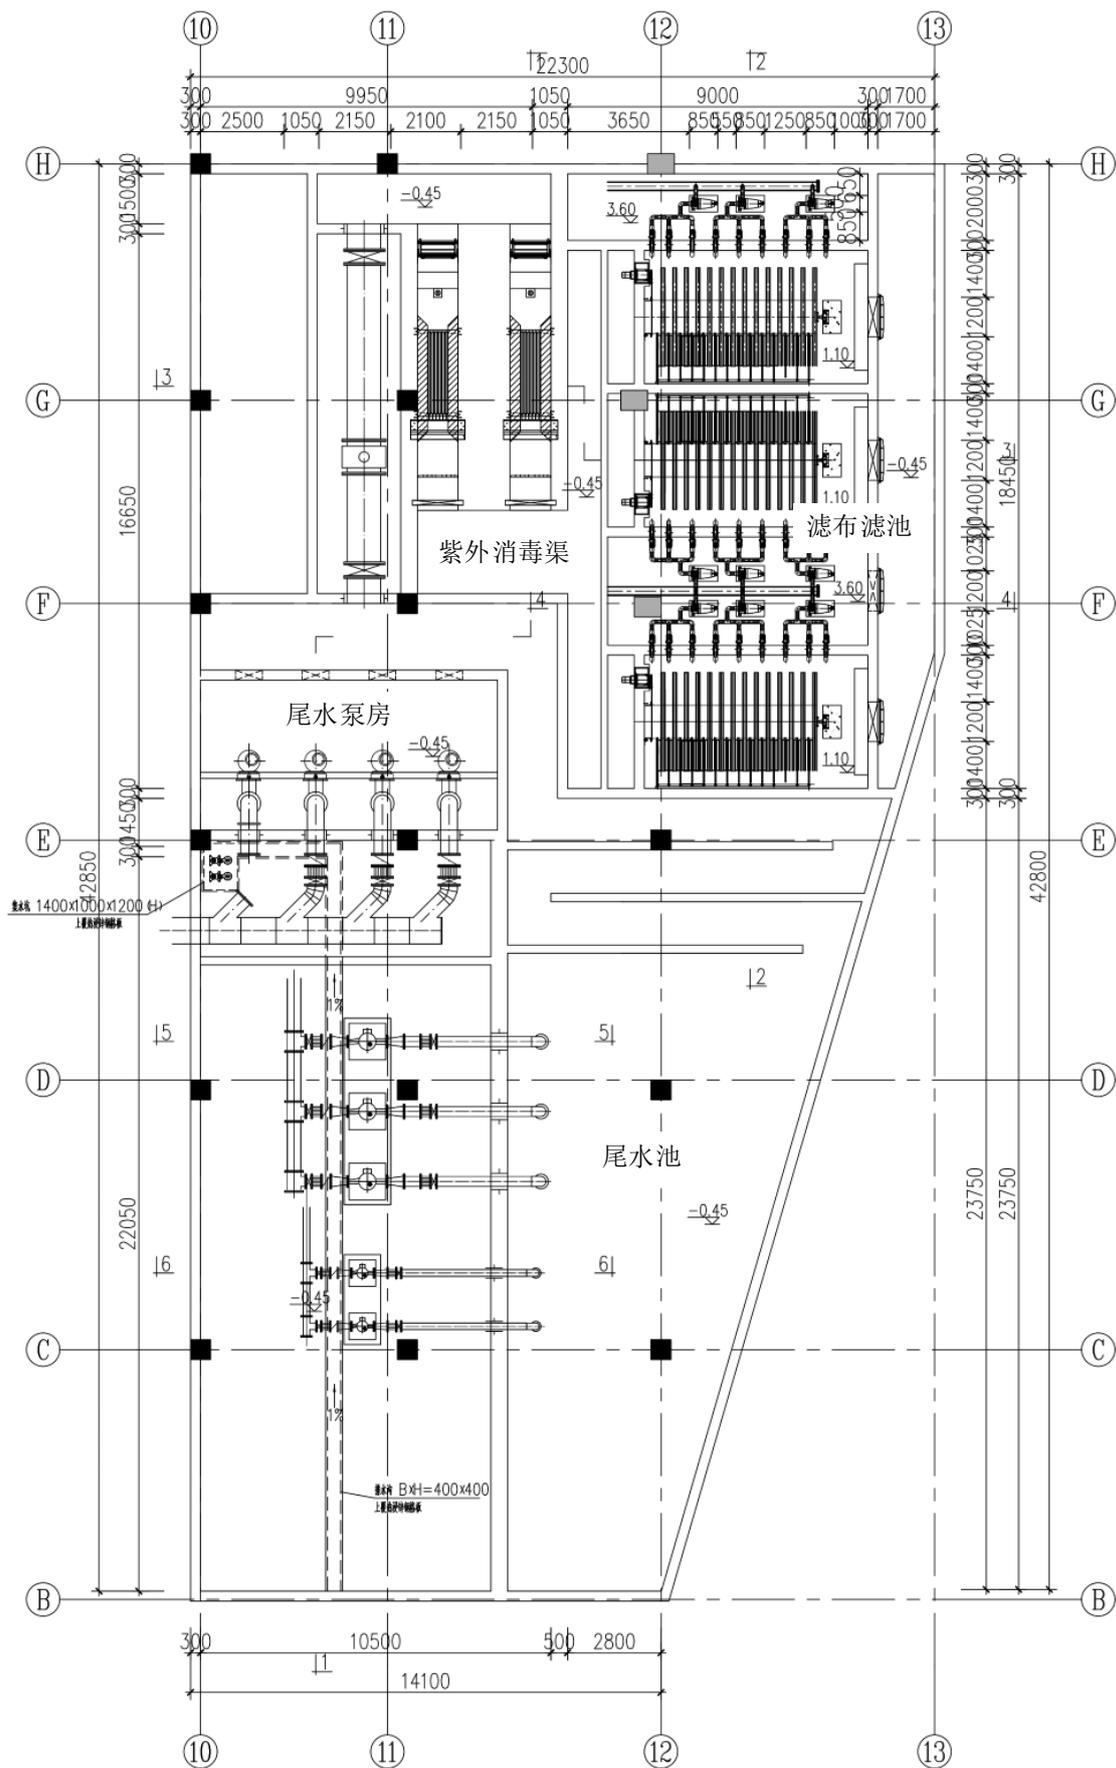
滤布滤池、紫外消毒渠、尾水泵房平面图
